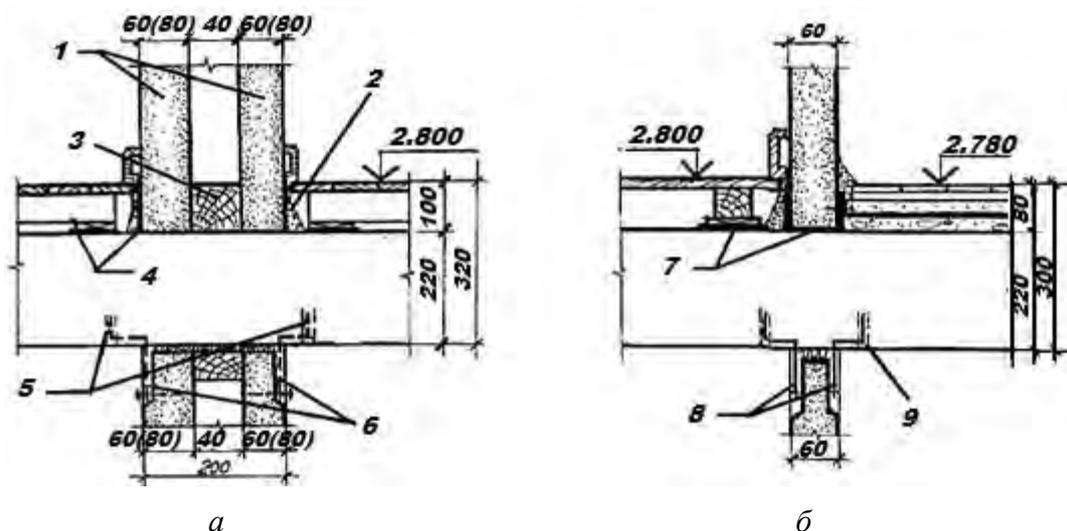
Варианты сопряжений гипсобетонных перегородок: *а* — между квартирами; *б* — в санузлах: 1 — гипсобетонные (шлакобетонные) перегородки; 2 — промазка гипсовым раствором; 3 — антисептированный брус; 4 — толь; 5, 9 — отверстие d 8 мм, просверленное по месту; 6 — закрепы, забитые заподлицо с плоскостью потолка; 7 — толь; 8 — закрепы
